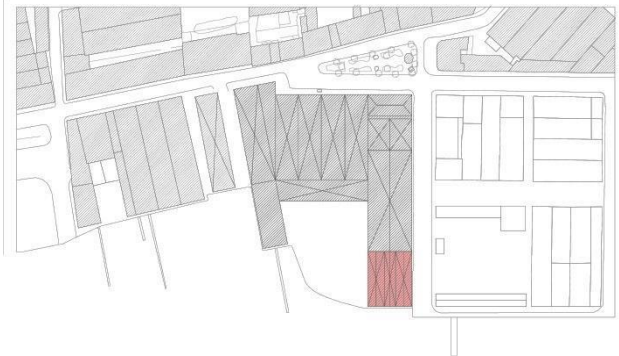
Reconstituição da planta de 1921, segundo anexo VI.
